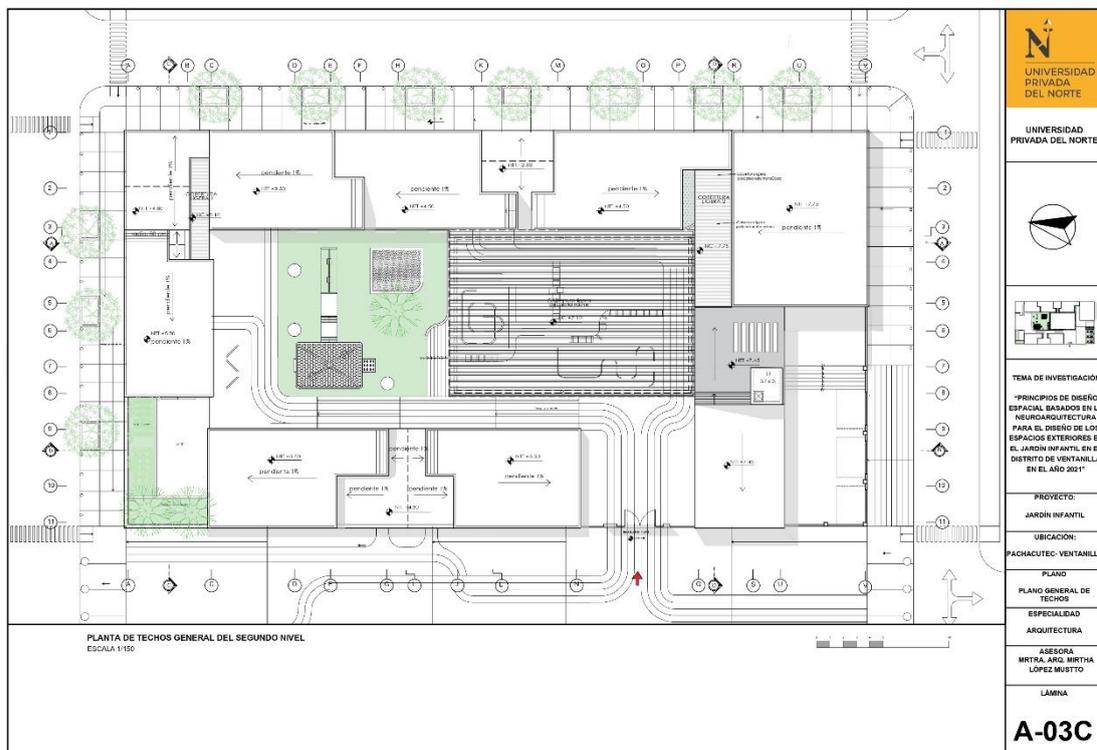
Planta de techos del Jardín Infantil. Fuente: elaboración propia
